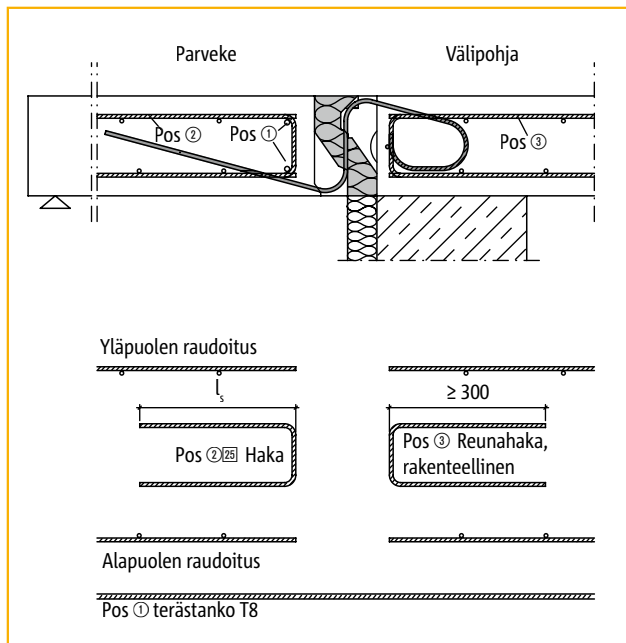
Leikkaus, elementtiparvekelaaatta, Schöck Isokorb® V6/6-H160
